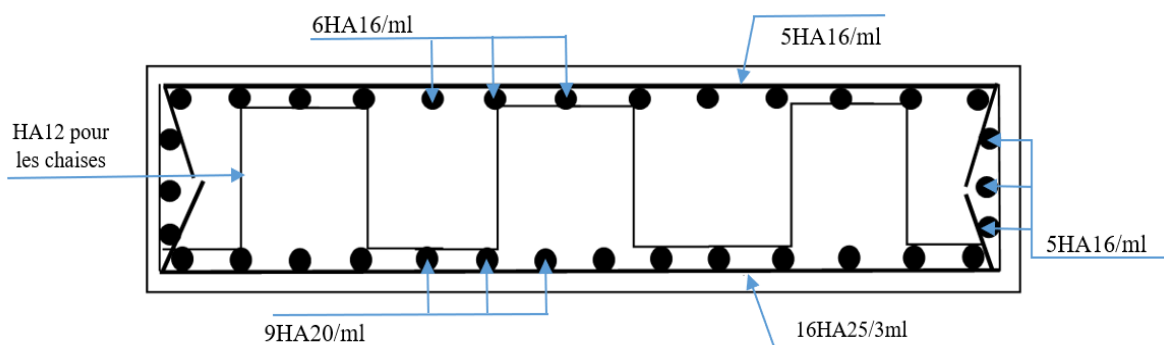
FERRAILAGE DE LA SEMELLE
